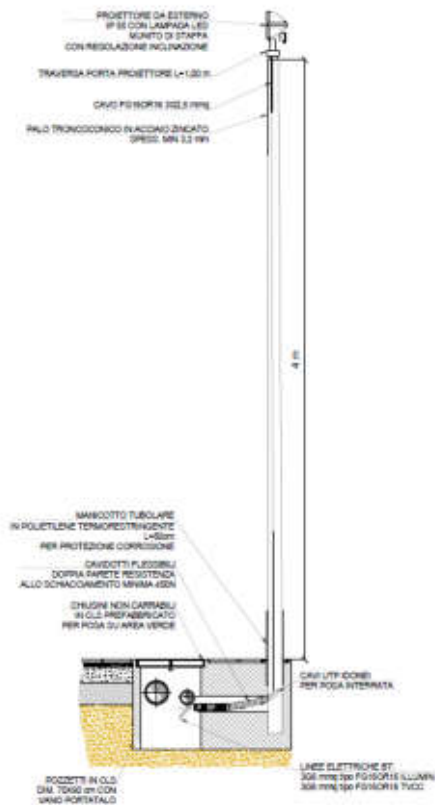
Estratto dell'elaborato grafico di progetto con i particolari costruttivi del sistema di illuminazione perimetrale previsto.
